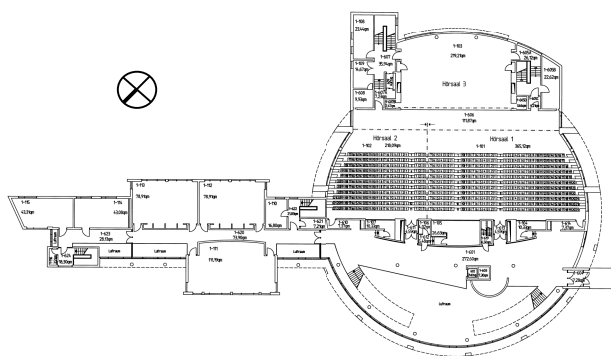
Grundriss (Maßstab ca. 1:800)
